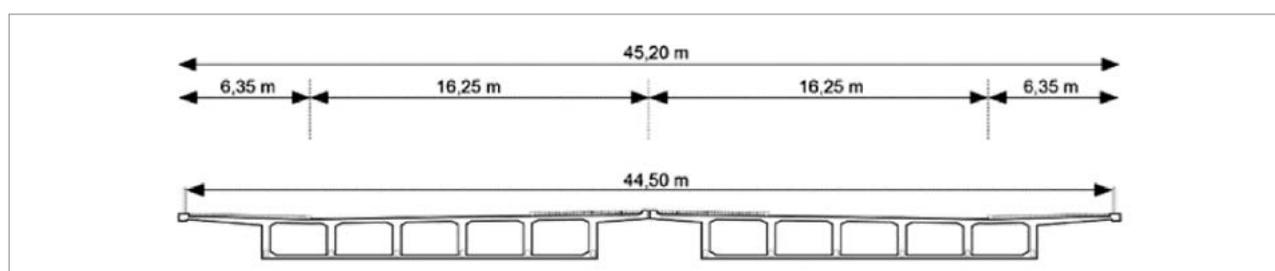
Querschnitt der Mühlendammbrücke – Bestandsbrücke
